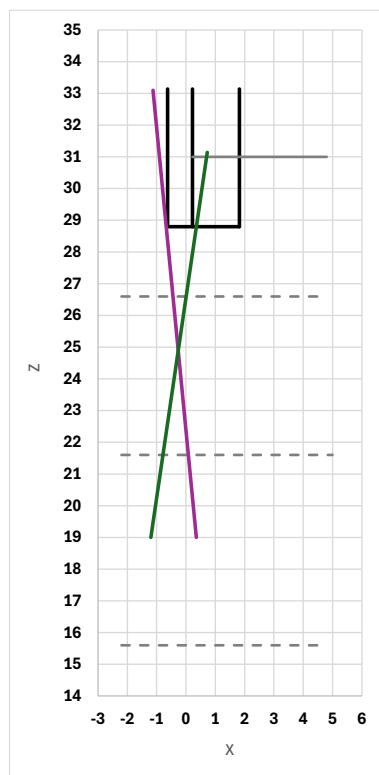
Schéma des tirs des lignes de colonnes de jet grouting pour la fondation B - Galerie Dauphine
